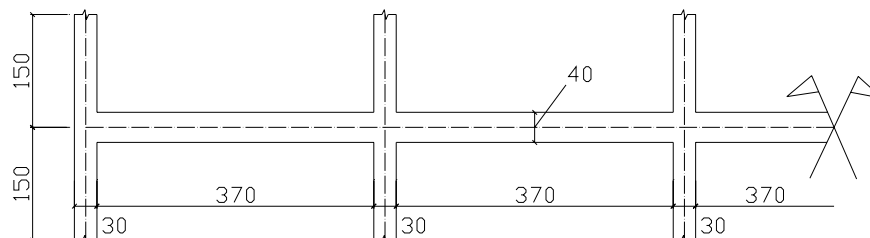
Geometria da viga, Caso 1 (dimensões em cm)
